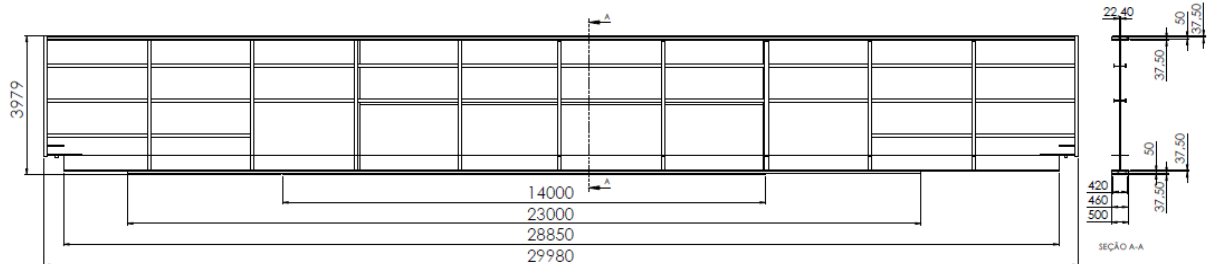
Dimensões principais do perfil principal da viga de rolamento
